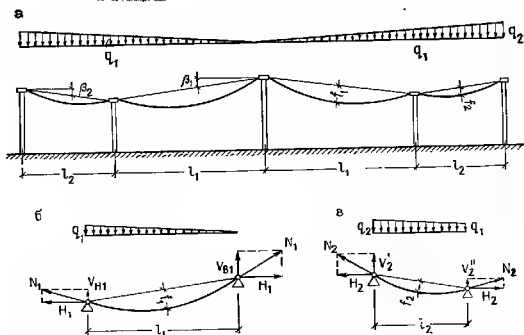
Расчетная схема многопролетного шатрового покрытия
